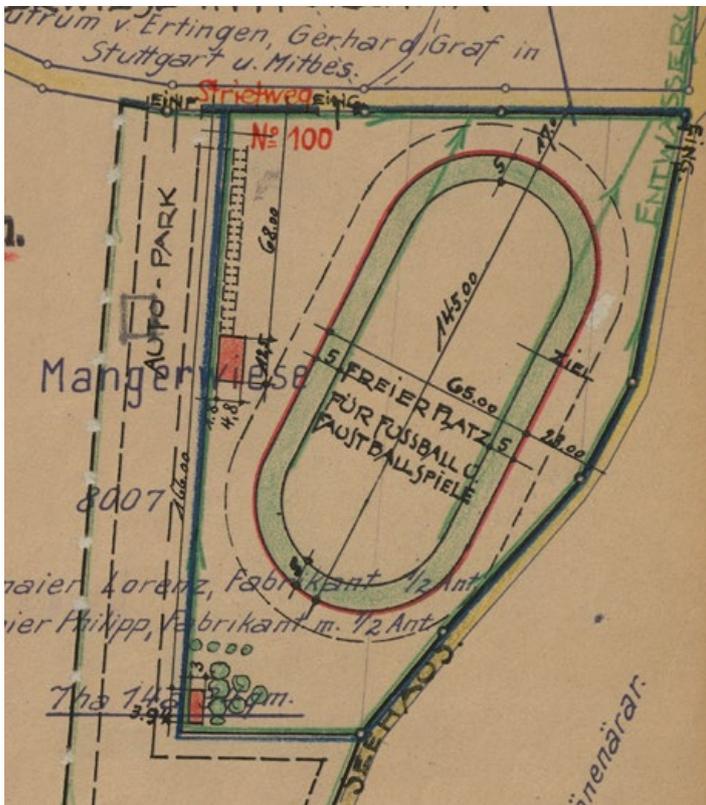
Lageplan der Radrennbahn (Stadtarchiv Pforzheim, B63-Strietweg 100)
